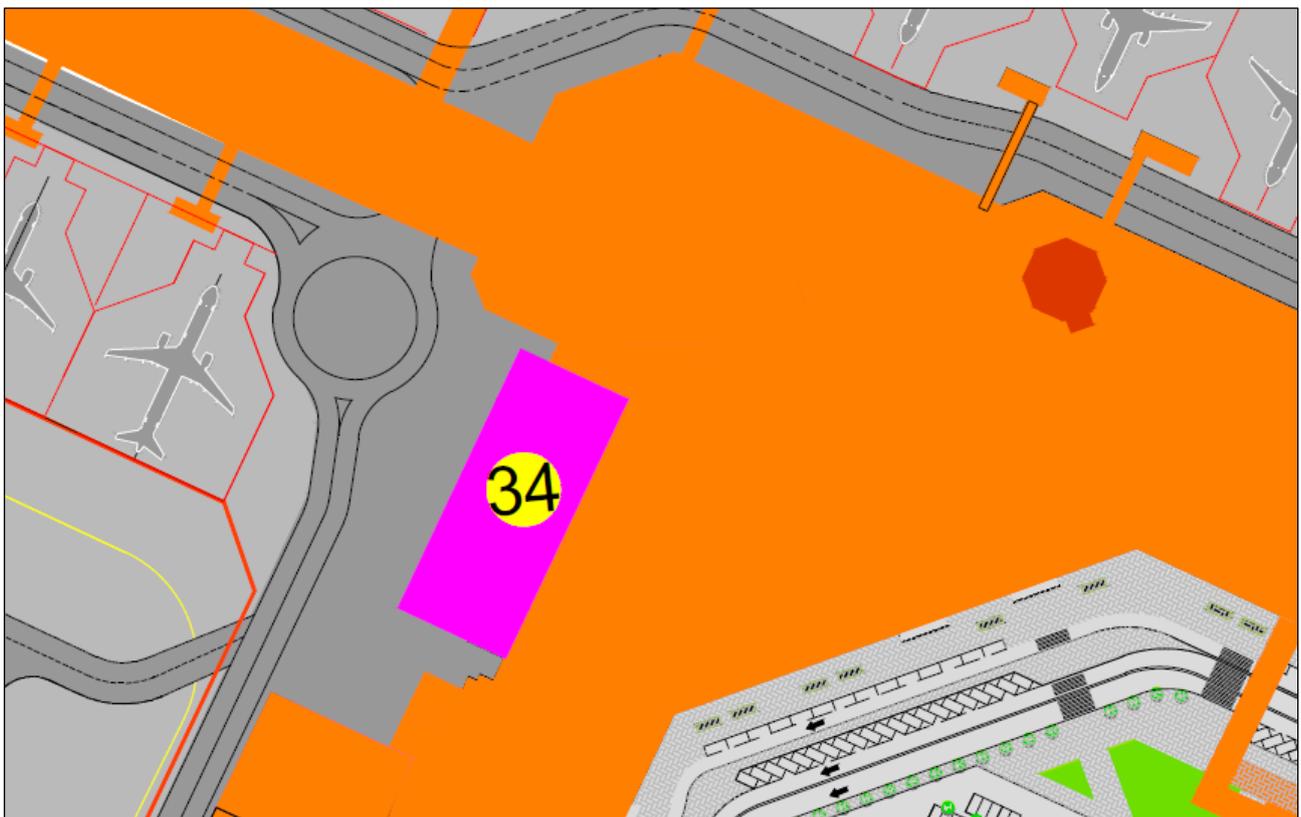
Estratto Master Plan – Ampliamento Sala Imbarchi
